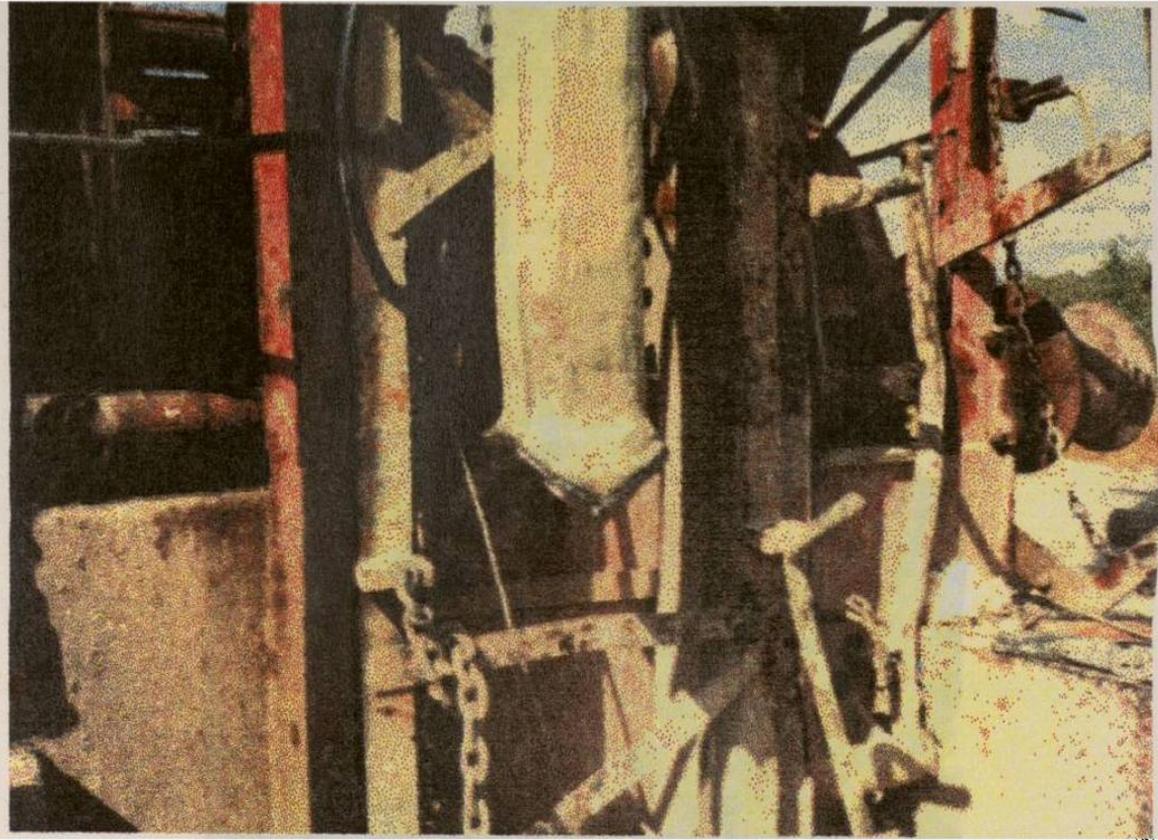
Punta de barrena ya reparada, mediante soldadura.
